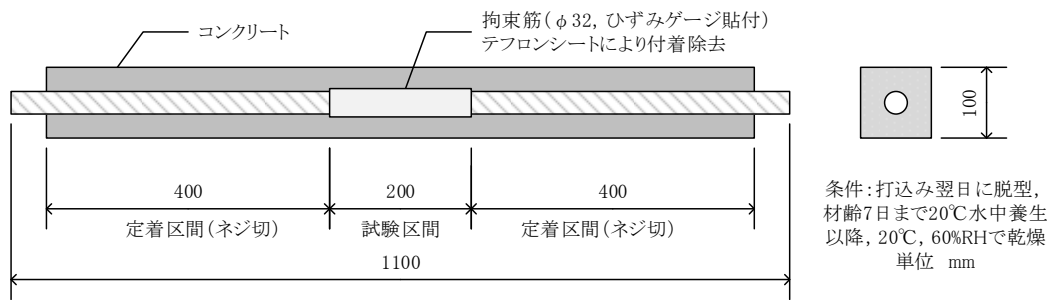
ひび割れ抵抗性試験体の詳細
